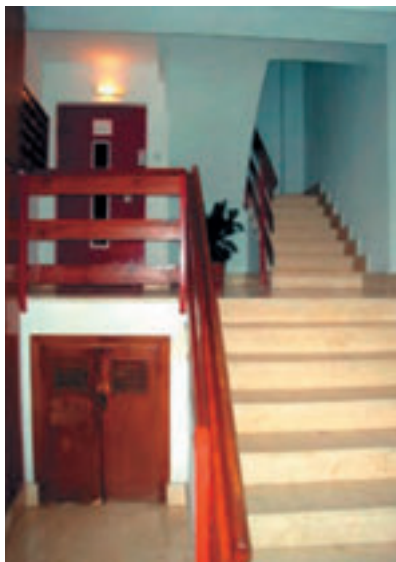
Reforma de ascensor para posibilitar acceso a planta calle.
